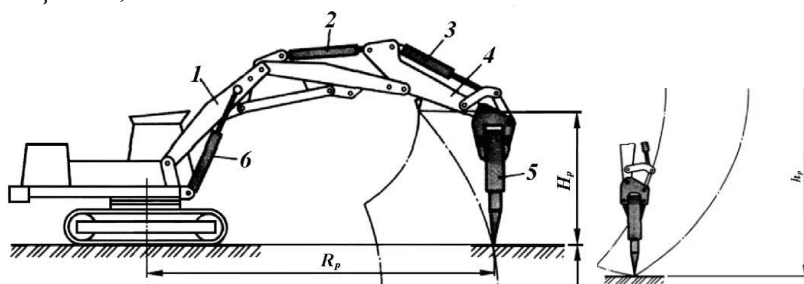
Рабочее оборудование гидромолота на экскаваторе:
